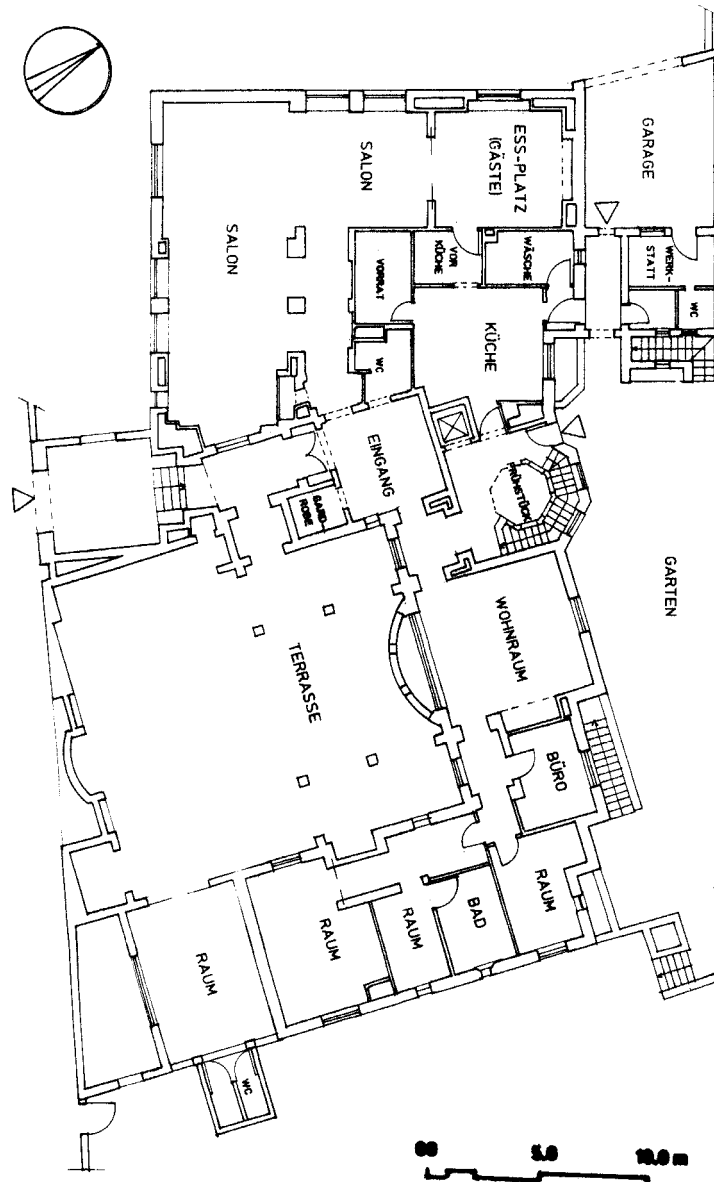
Erdgeschossplan eines zweigeschossigen modernen Wohnhauses
